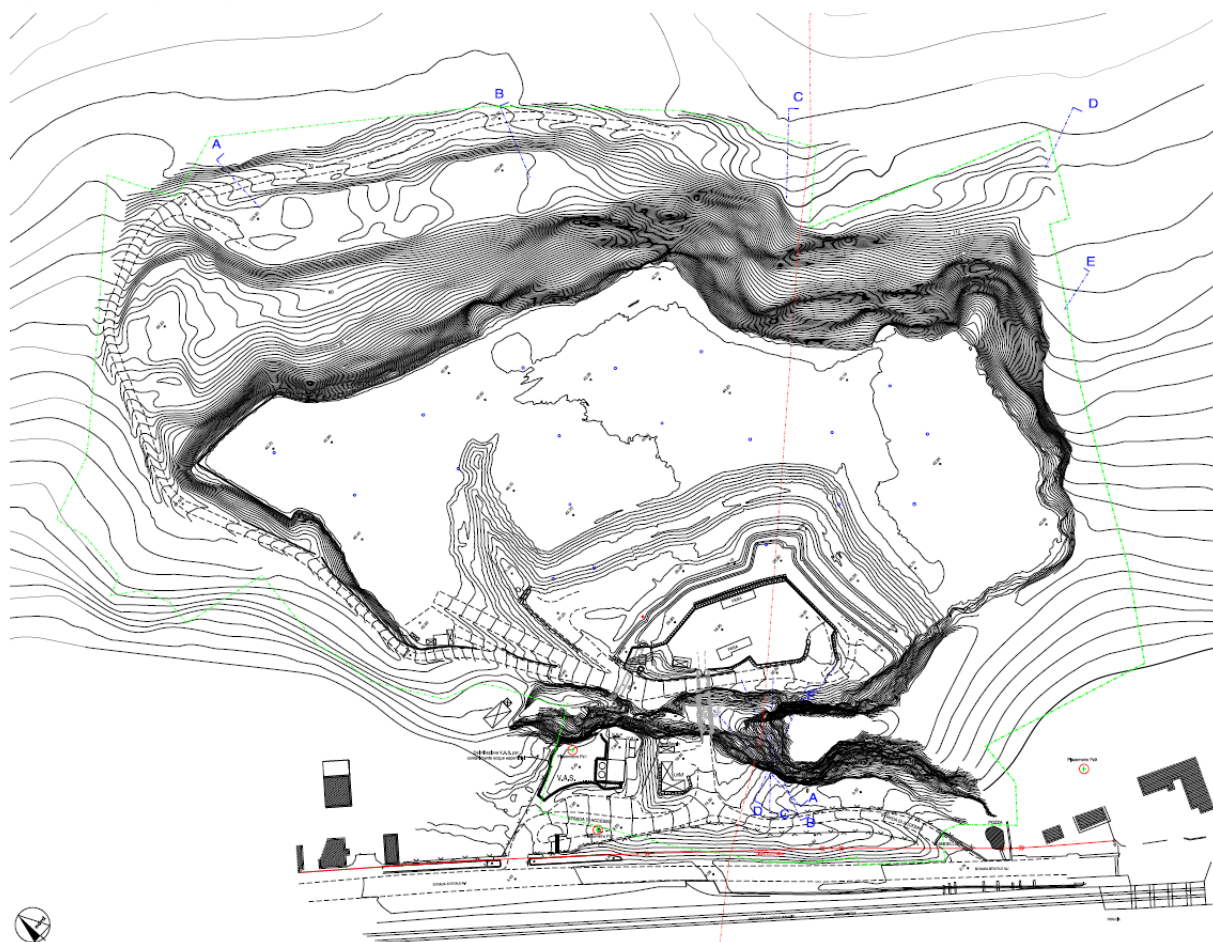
estratto planimetria generale, tavola prog. T.02
